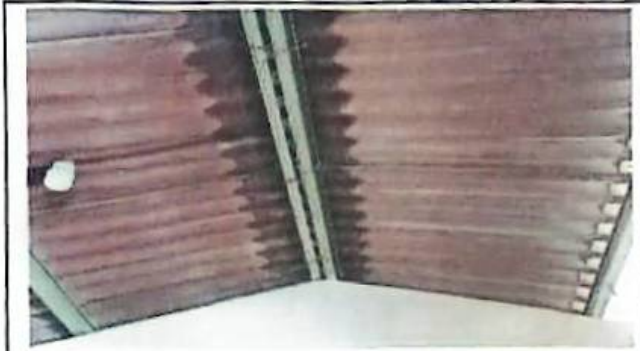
Esta imagen muestra otro salón con vista interior, con techo agrietado.
